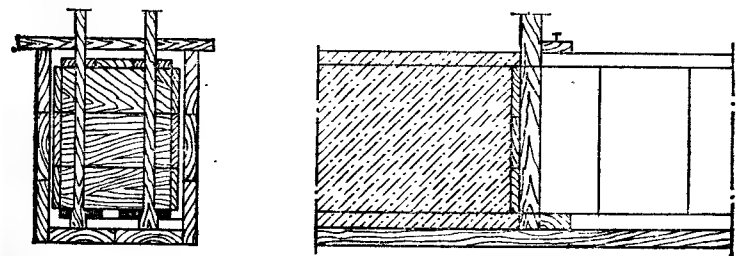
Устройство рабочего шва в балке перекрытия
